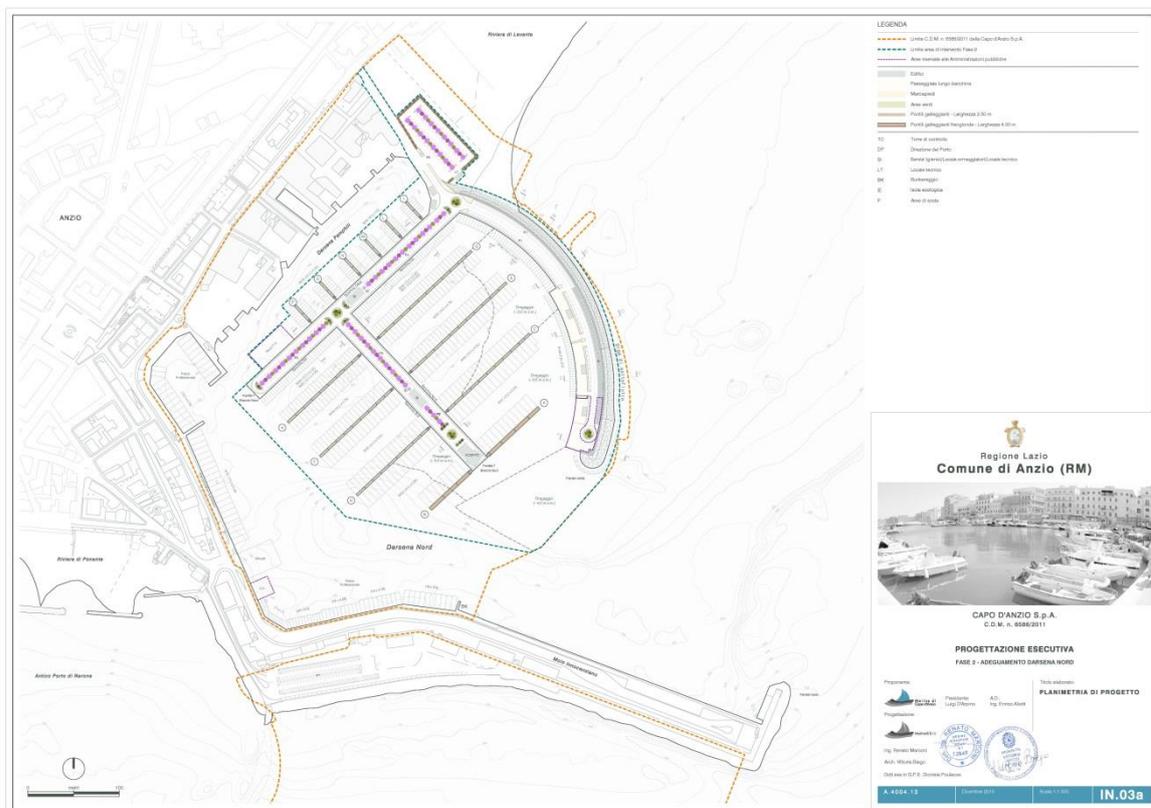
Elab. grafico IN.03a – Planimetria di progetto
